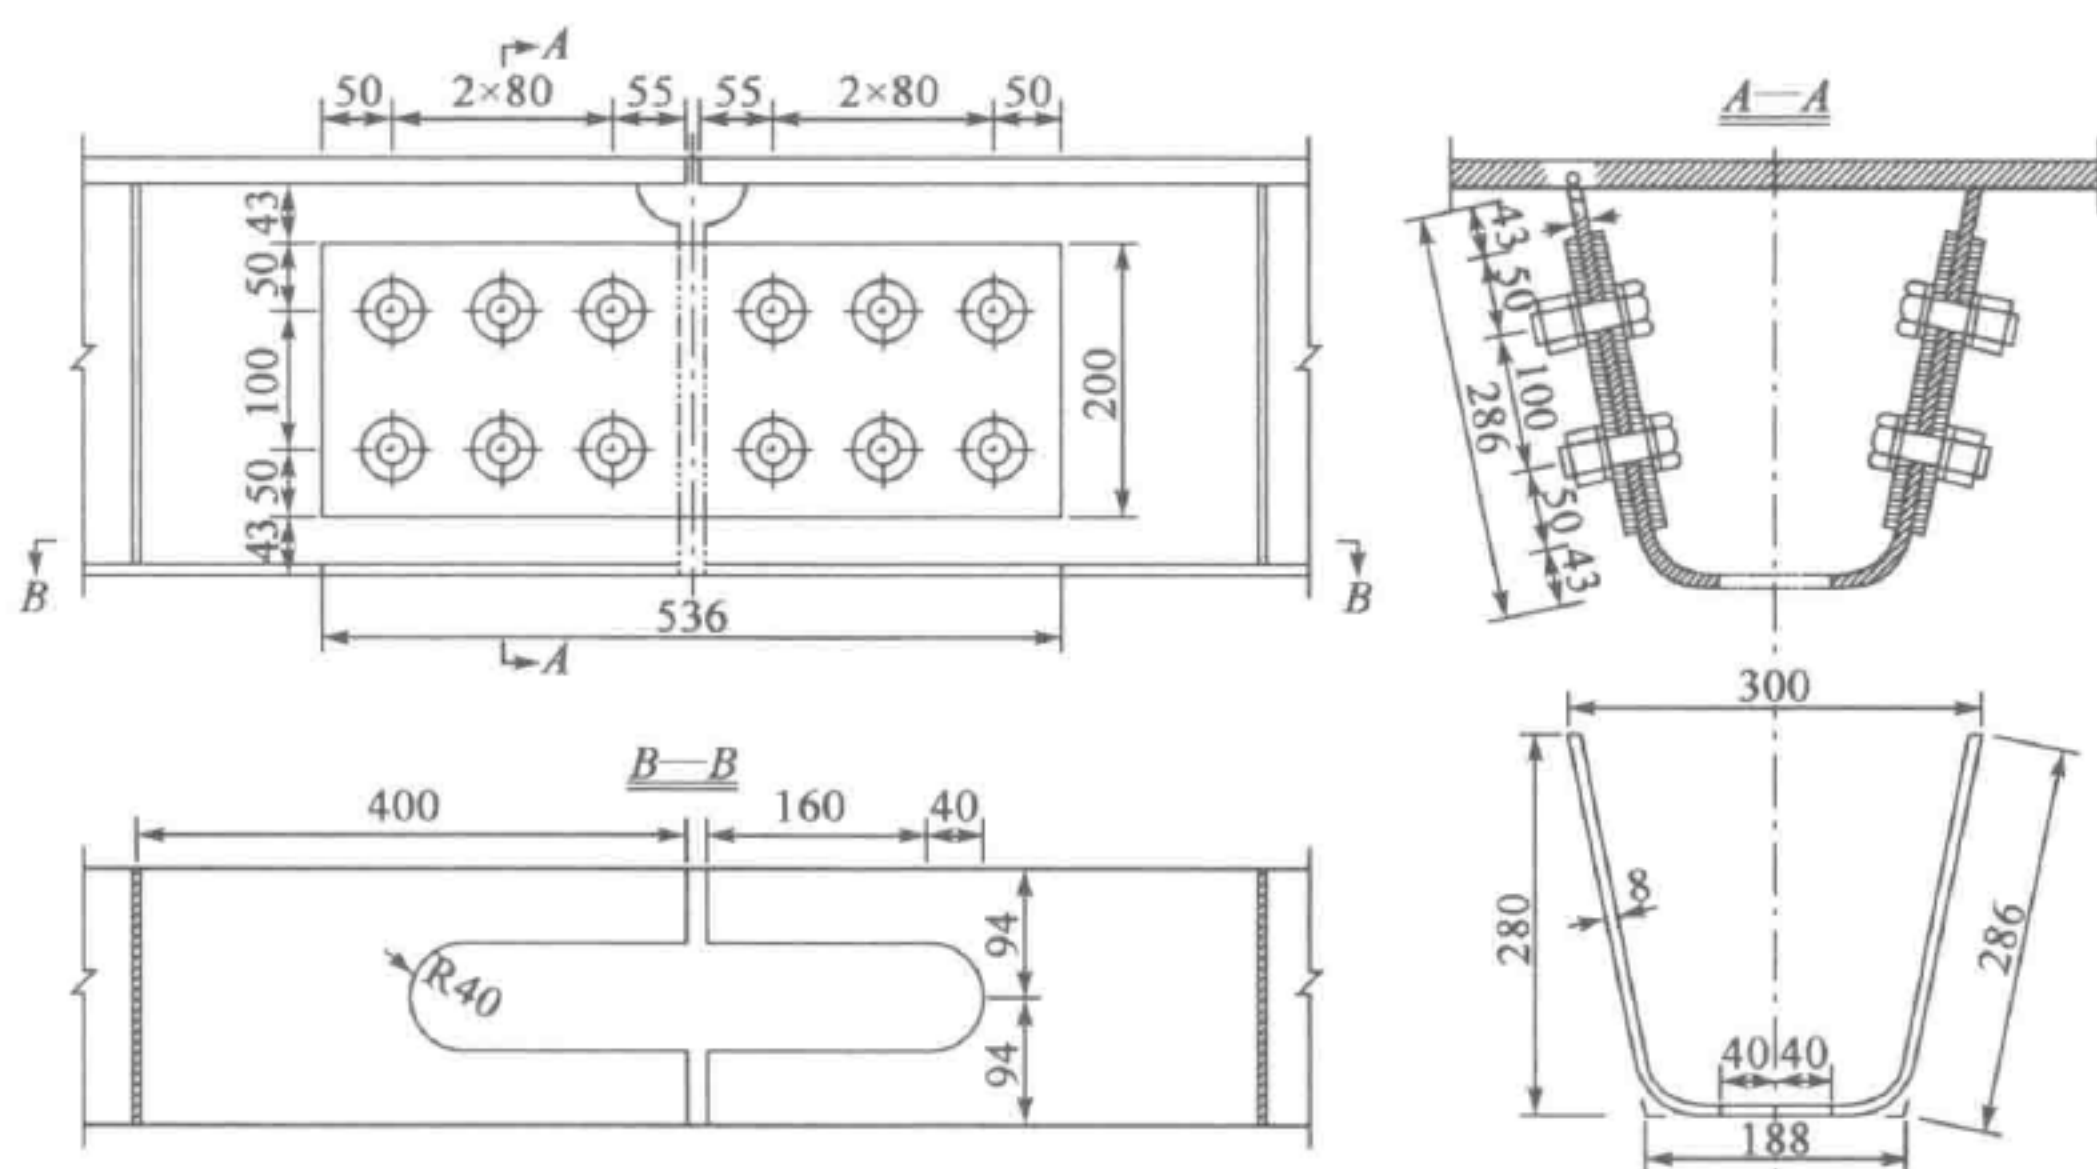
U 肋螺栓连接构造(尺寸单位:mm)
